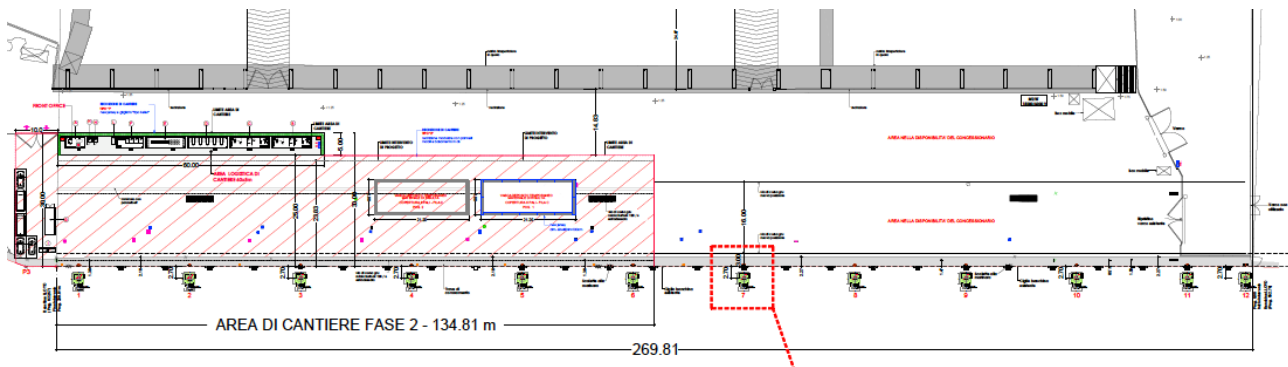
Banchina Lloyd – Area di cantiere Fase 2
